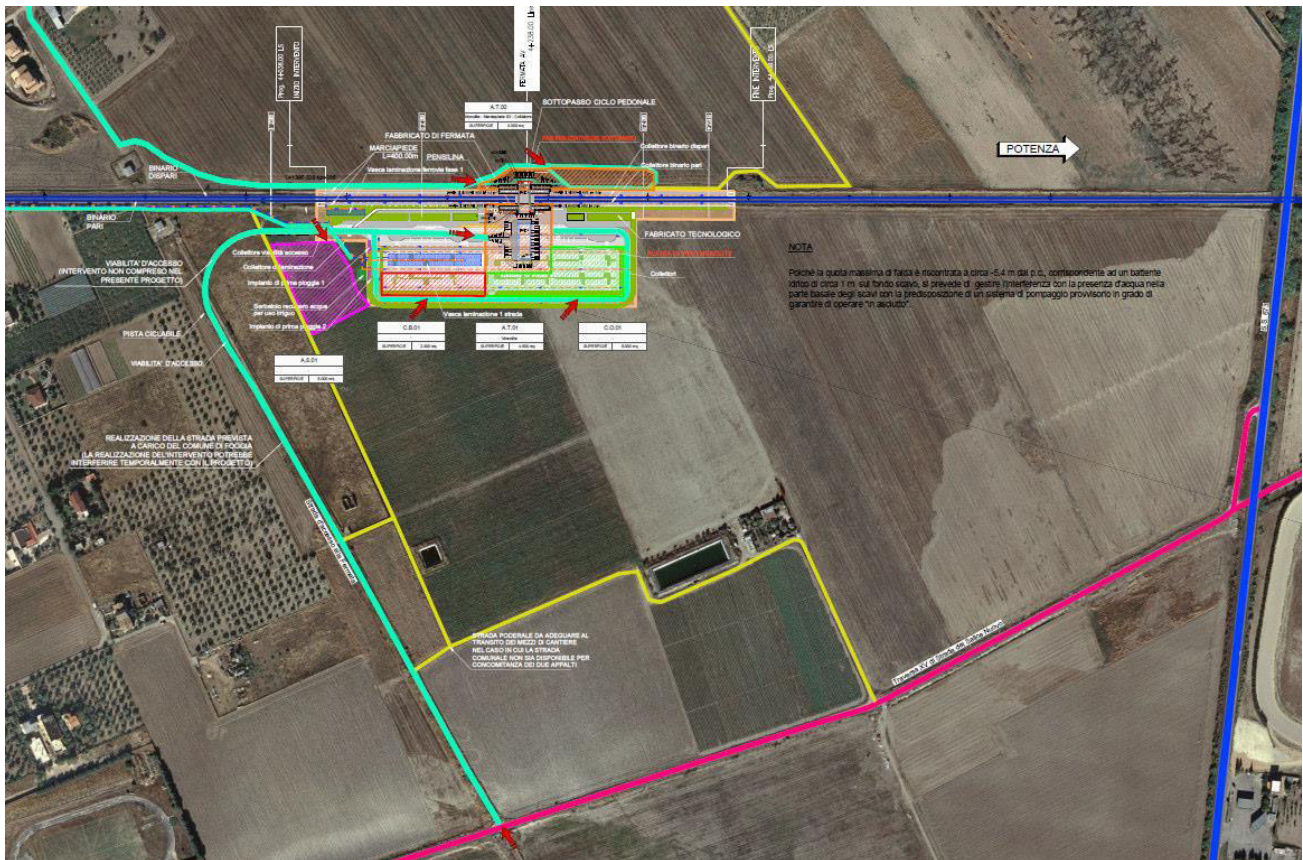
Planimetria di Cantierizzazione e viabilità di accesso alle aree di cantiere
